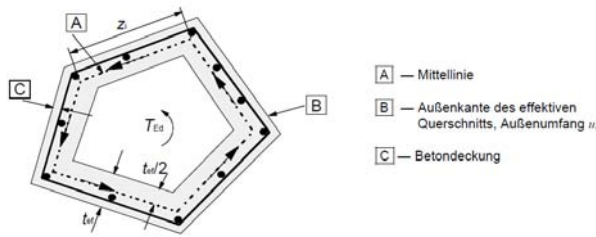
In 6.3 verwendete Formelzeichen und Definitionen
